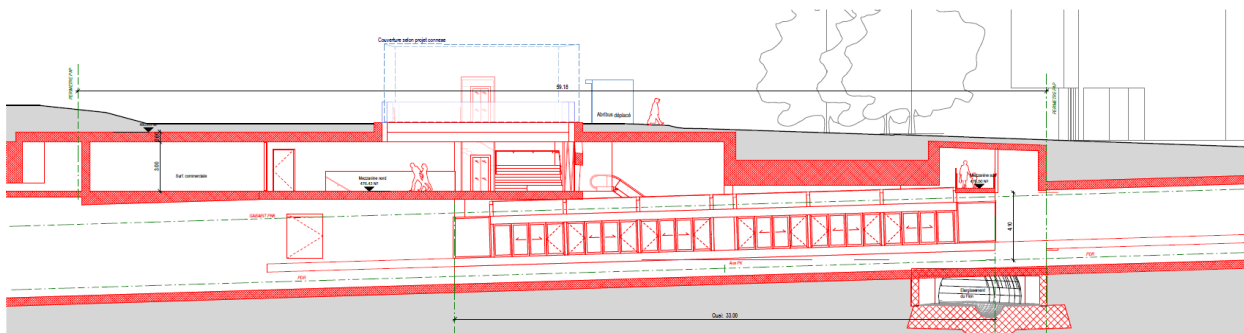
Coupe longitudinale de la station Flon. Le tunnel du m3 présente un dénivelé de 2.98%.
